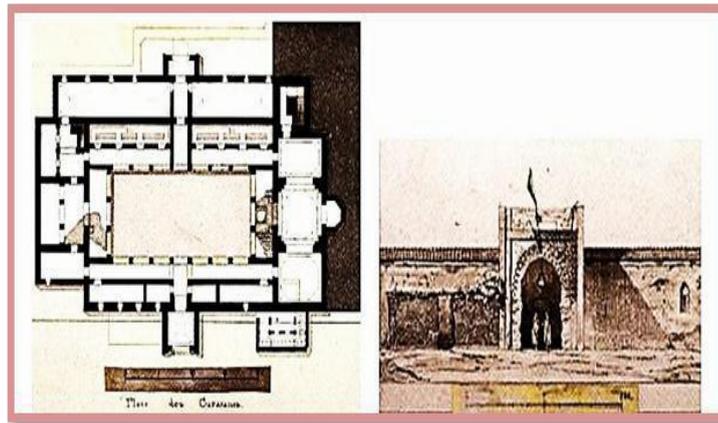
plan et Façade de la Medersa Tachfinia par E.Danjou, 1873
